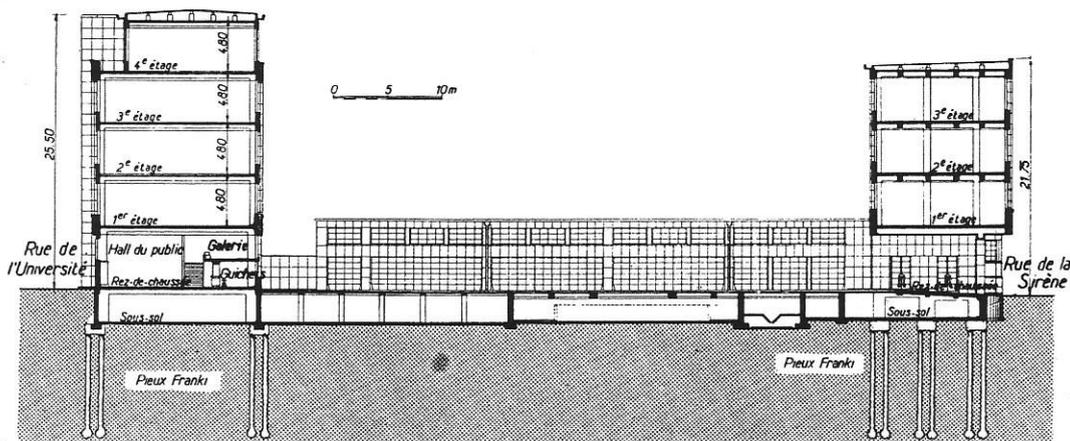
COUPE LONGITUDINALE. L'ossature des bâtiments est en béton armé. Les fondations sont constituées par 620 pieux Franki de 10 m de longueur et de 65 t de force portante moyenne.
